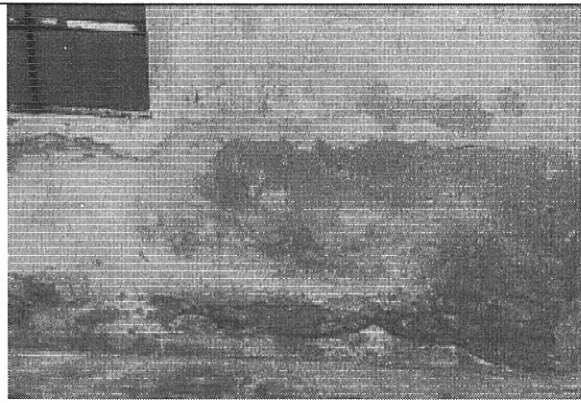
Deterioro y humedad en la parte inferior del muro de fachada
